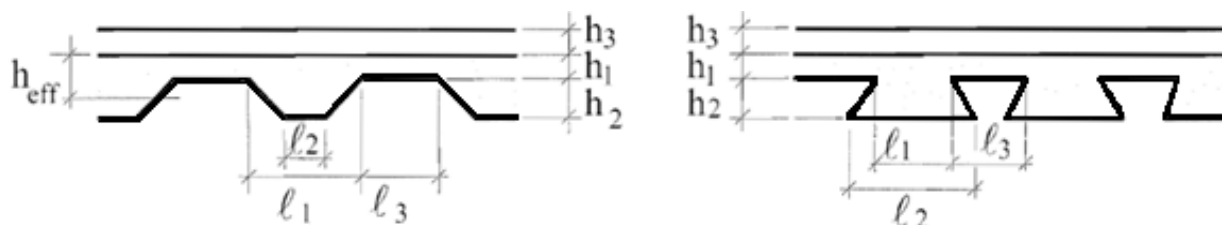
Dimensões da seção transversal da laje mista trapezoidal à esquerda e para as lajes mistas com reentrâncias à direita
